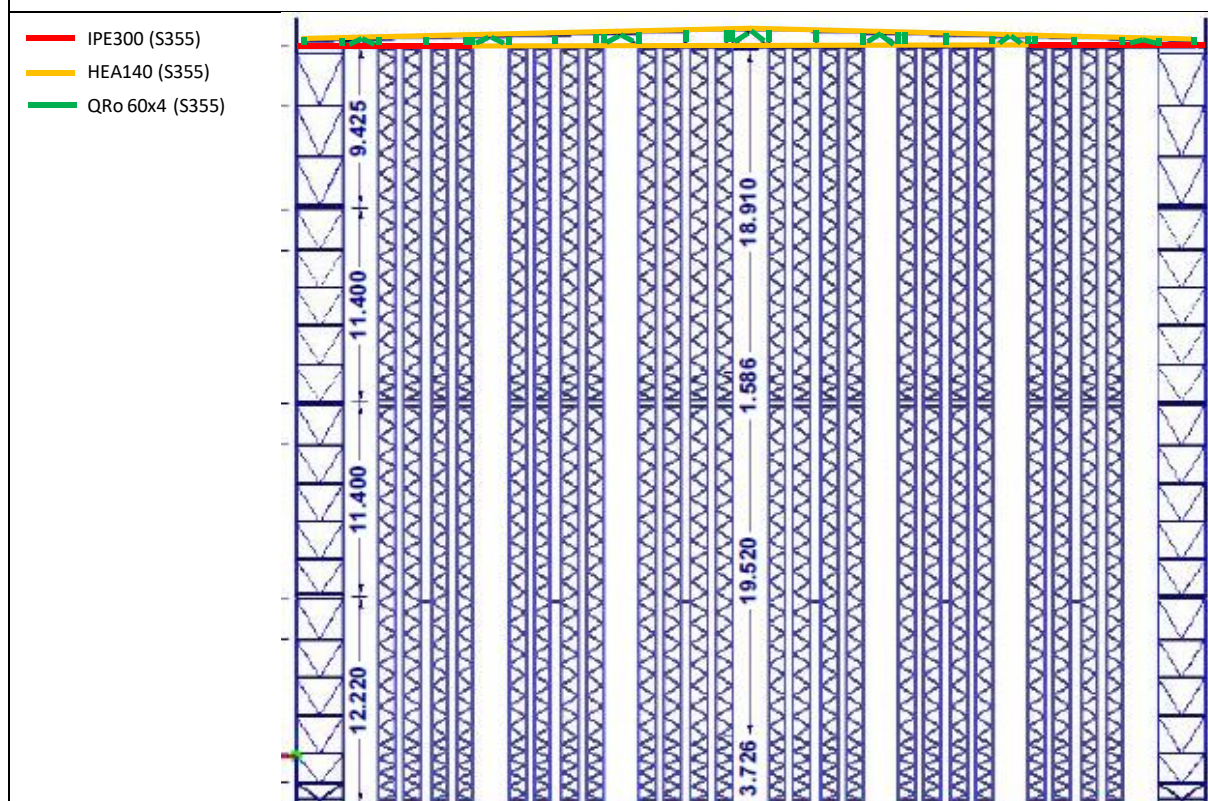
Matériaux et dimensions d'une section de lisse (plan de coupe longitudinal)
